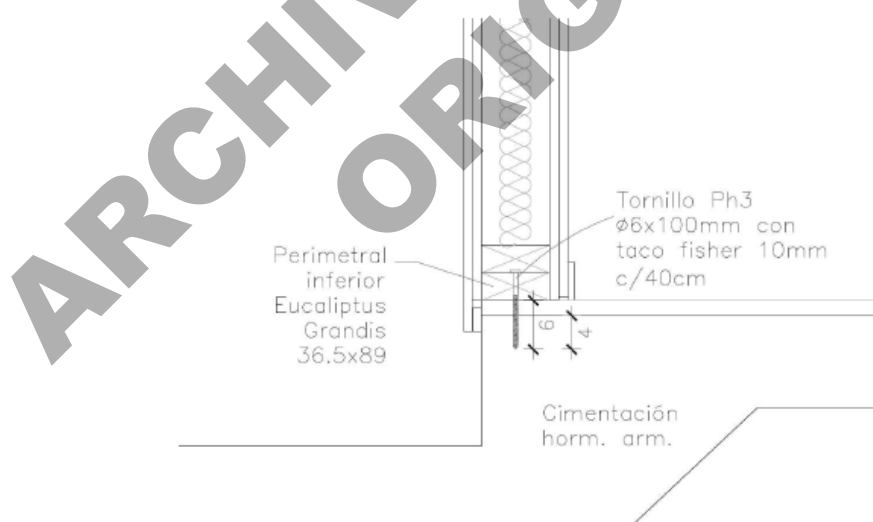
Unión perimetral inferior con cimentación de hormigón armado. Se realiza la verificación de la unión por tornillos entre el perimetral inferior y la cimentación de hormigón armado:
